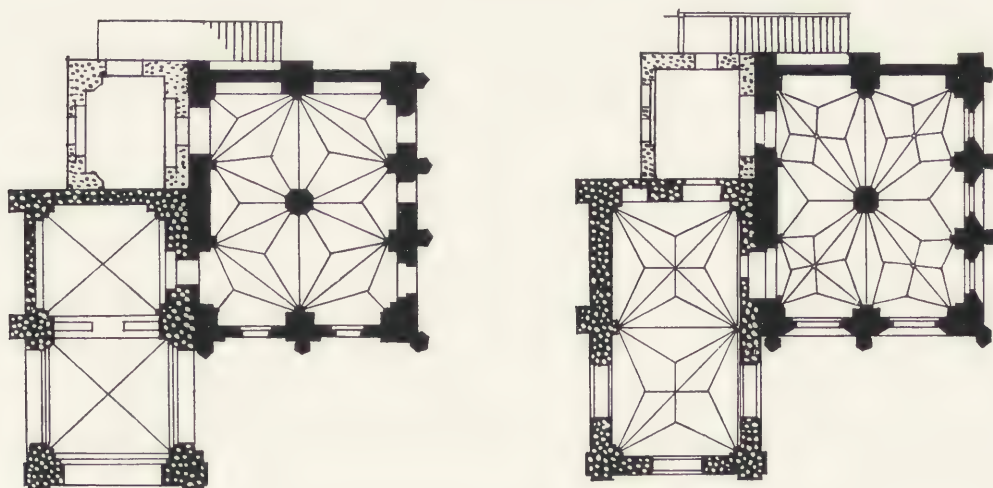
Rathaus zu Tangermünde. Grundrisse.
